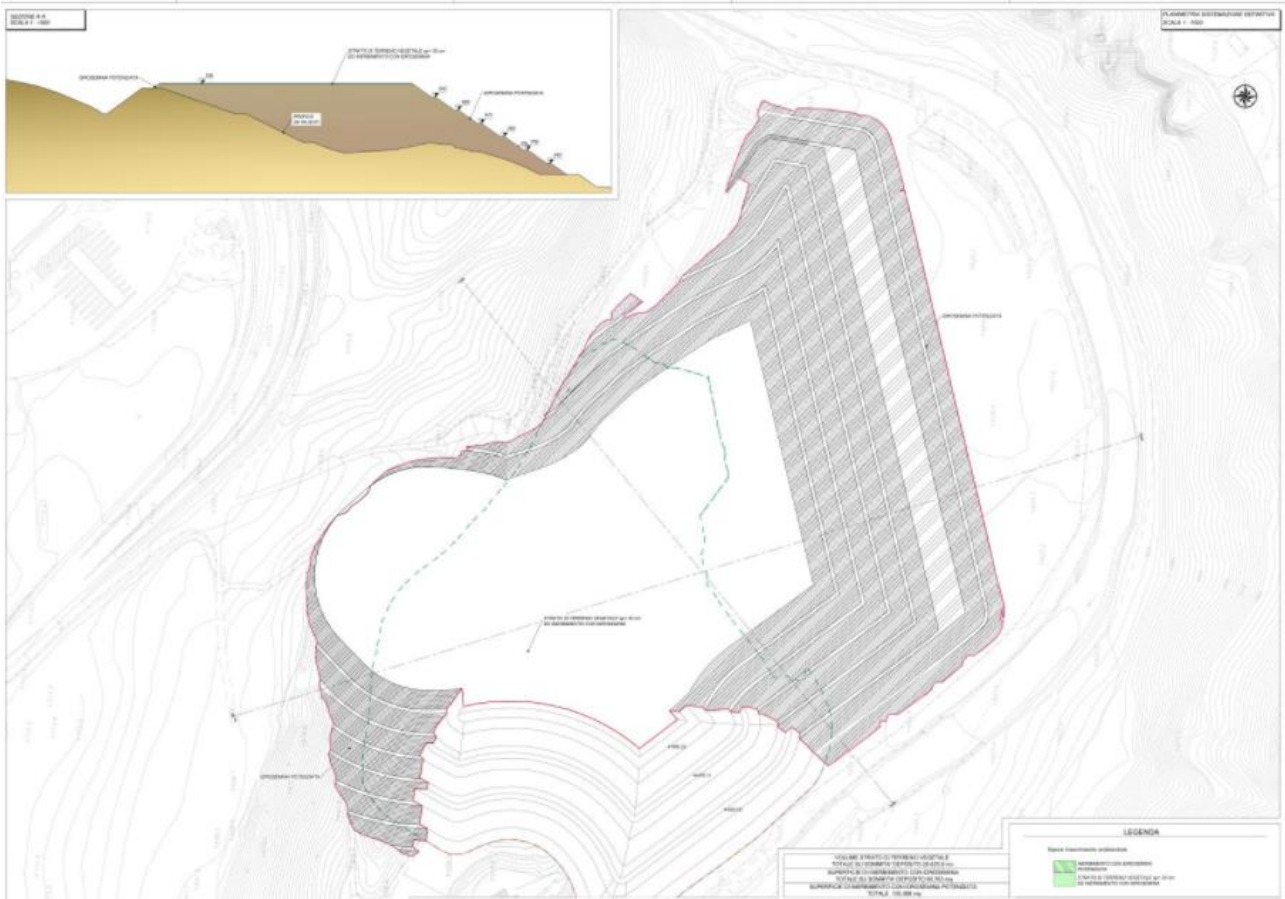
Opere a verde – Planimetria di progetto deposito di Hinterrigger.
